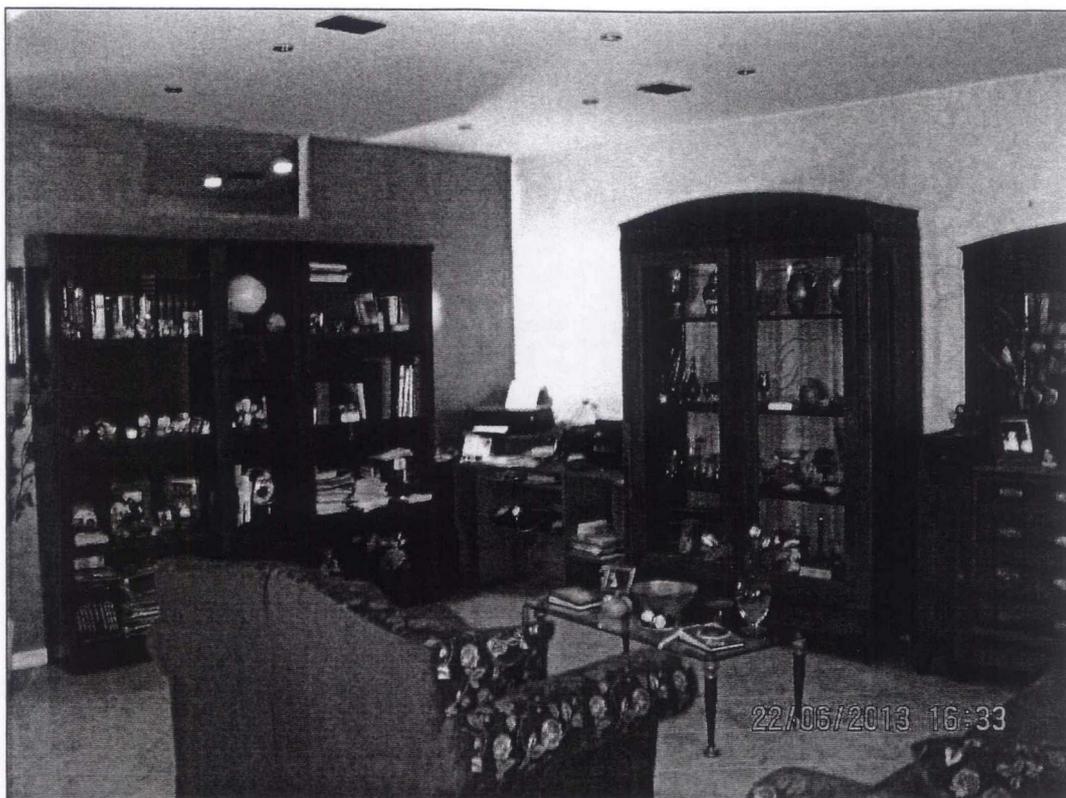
Vista del salone, dove si può riscontrare il punto luce della terza camera da letto ricavata da una parte del salone.
